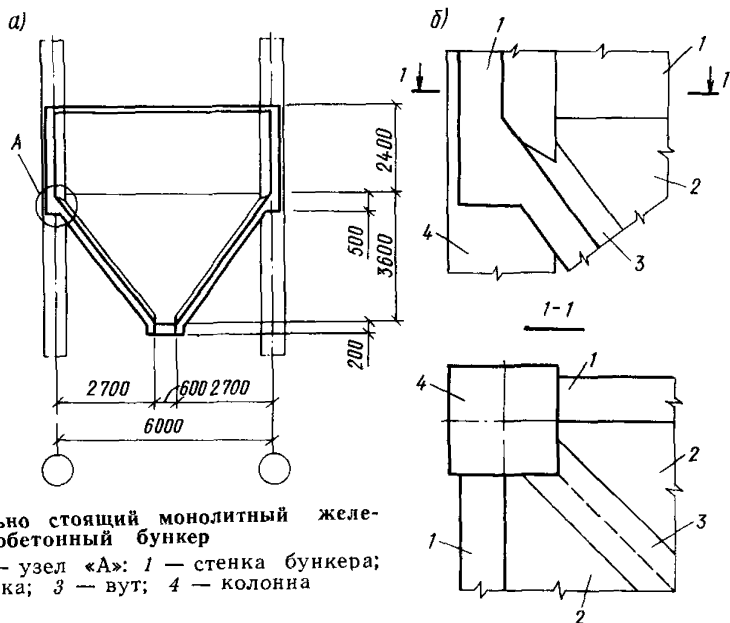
Отдельно стоящий монолитный железобетонный бункер
